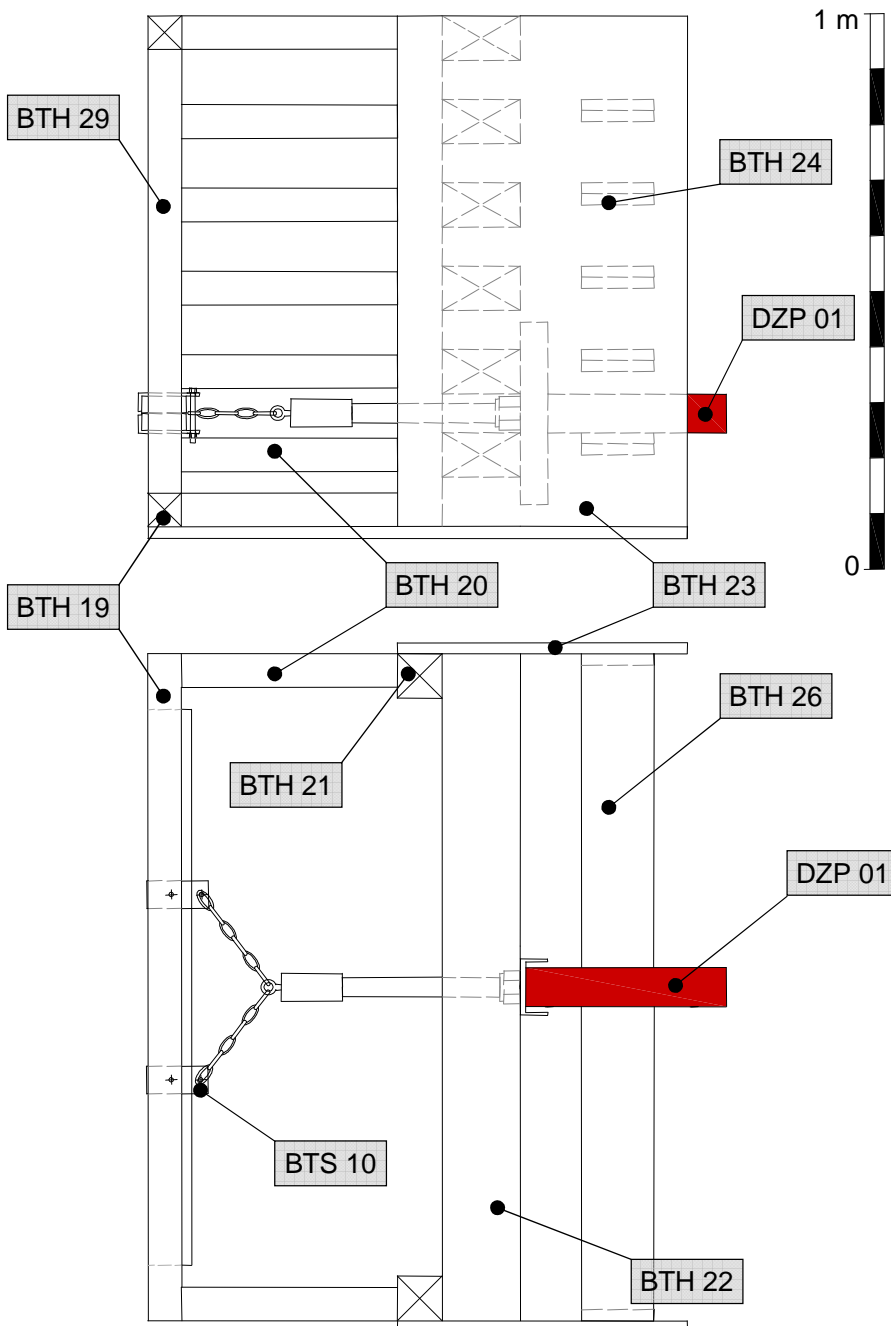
13 Seitenansicht und Draufsicht der Vorspanneinrichtung
